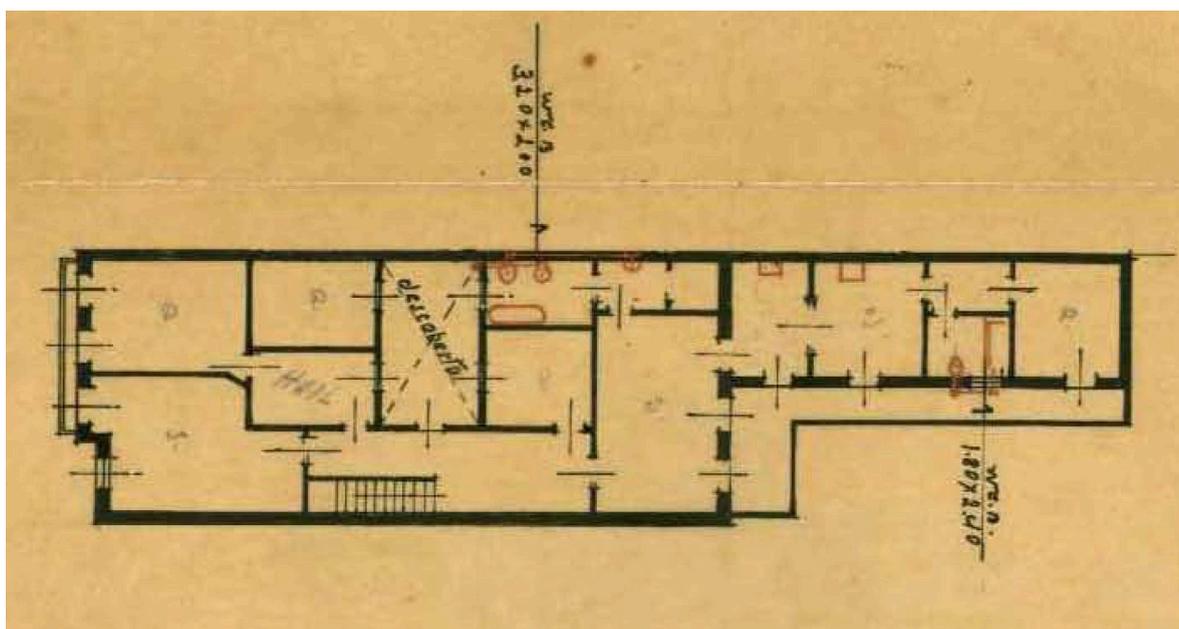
Recorte da planta baixa do segundo pavimento, com giro de 90° para a direita. Fachada da Rua da Imperatriz ao lado esquerdo da planta. Notar área descoberta ampliada em relação ao pavimento inferior, e varanda em L na lateral/fundos que dava acesso ao volume de serviço.
